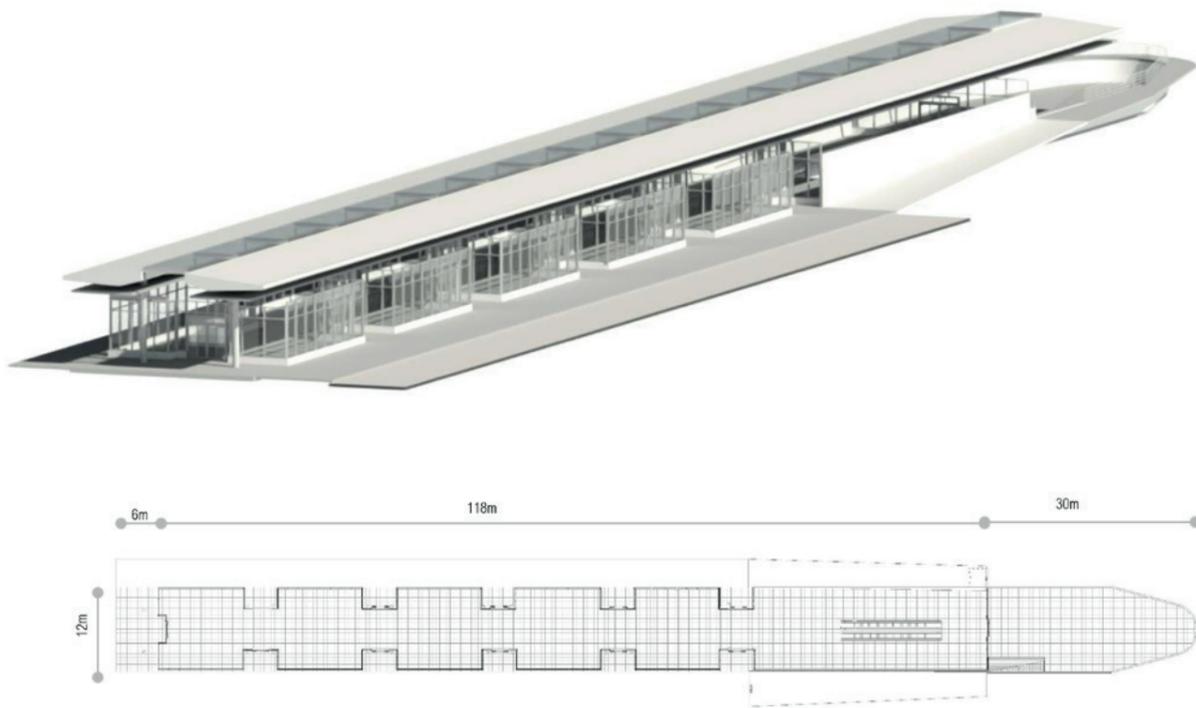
Planos levantados de la estación Canning Town. Fuente: Elaboración propia
